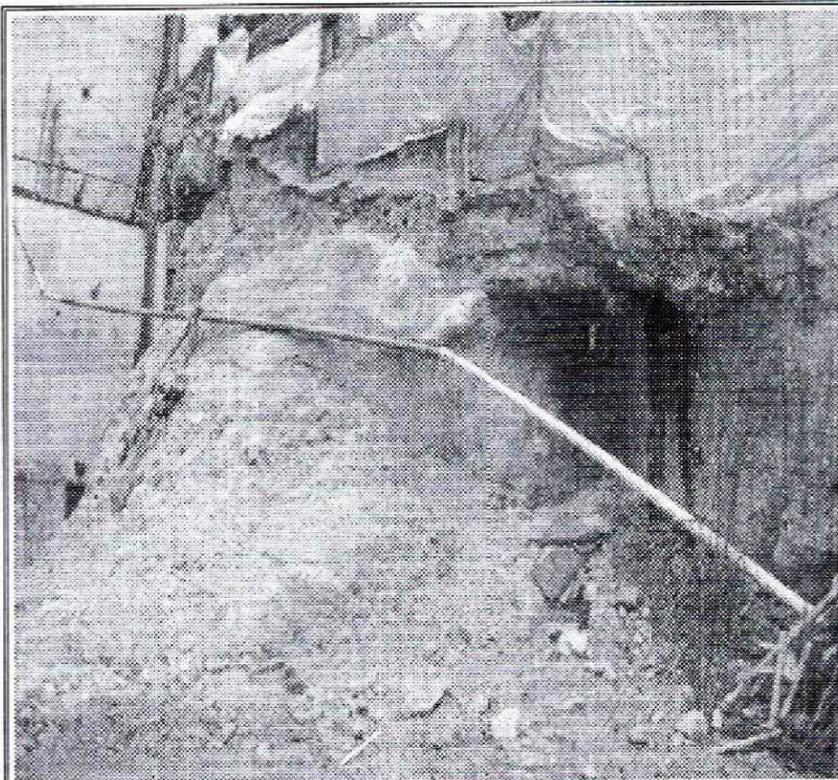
Vista excavación y conformación armadura acero de refuerzo muro de contención
